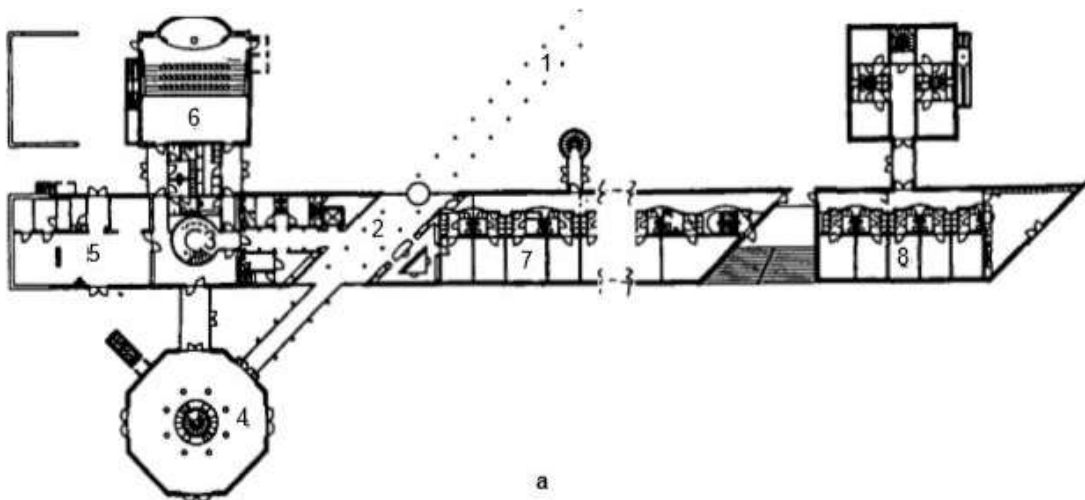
Planta do Pavimento Térreo. The Maersk Mckinney Moller Centre, Churchill College, Reino Unido. Fonte: ADLER, 1999.
